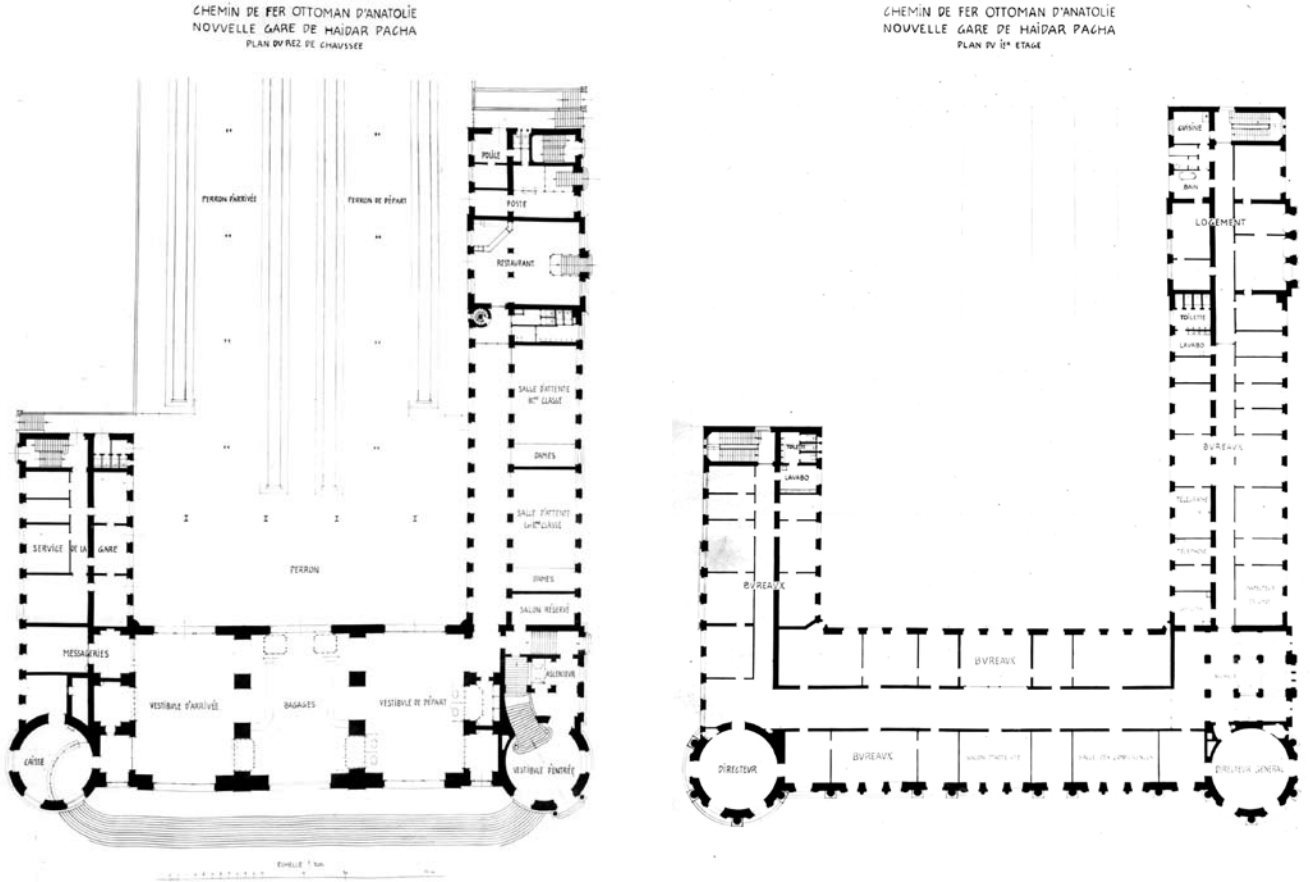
I. Kat Planı, 1906 (Istanbul Demiryolu Müzesi Arşivi).
